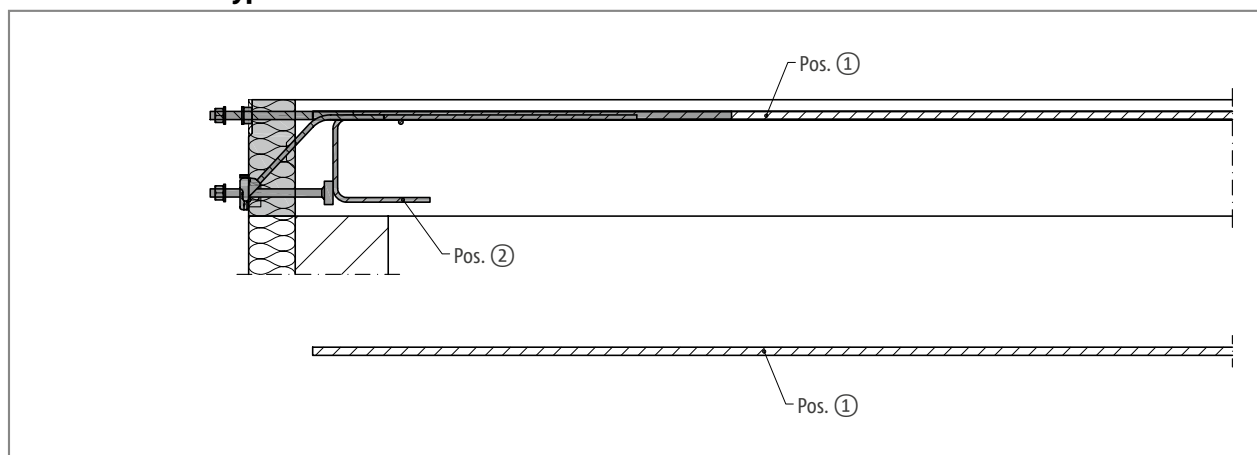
Schöck Isokorb® T type SK: Op de werf aangebrachte brandwerende bekleding, T type SK, staalconstructie met brandwerende coating; doorsnede
